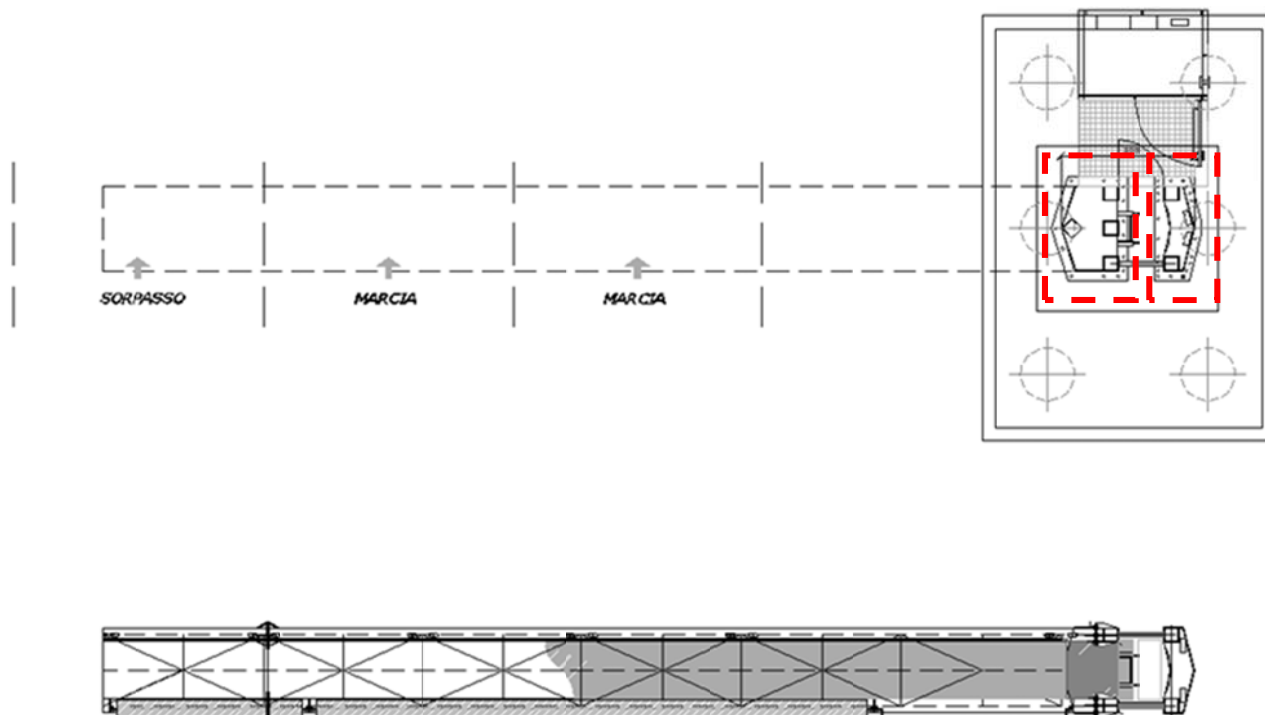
Vista in pianta e pianta del sistema di fondazione.
